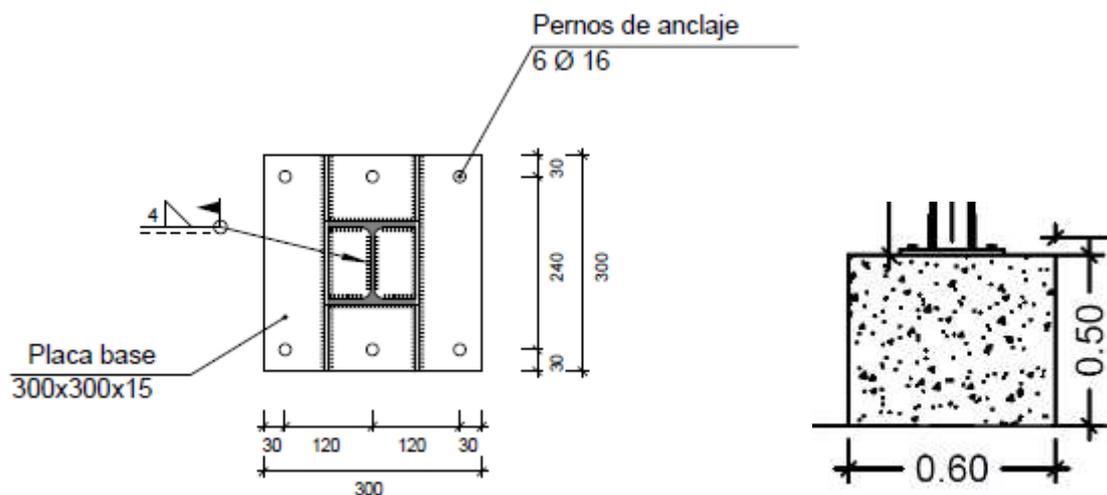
Esquemas de placas de anclaje (izquierda) y del bloque de hormigón (derecha).
